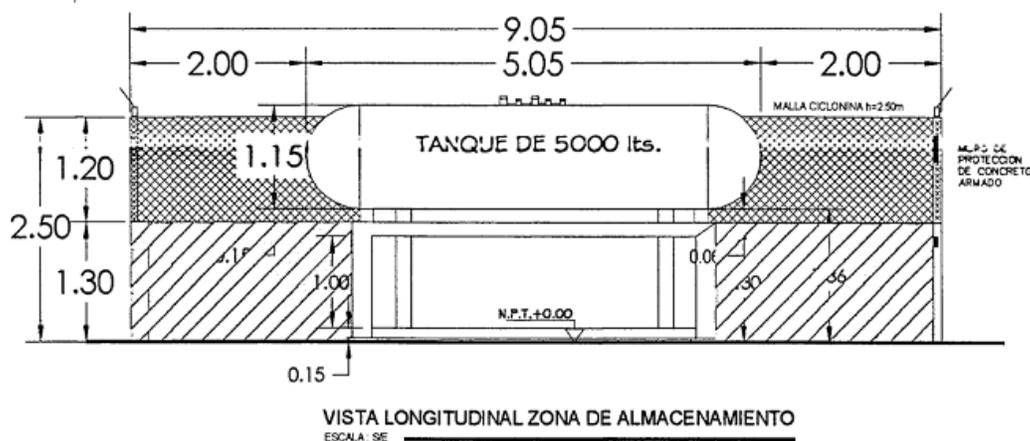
Vista longitudinal del Área de almacenamiento.
